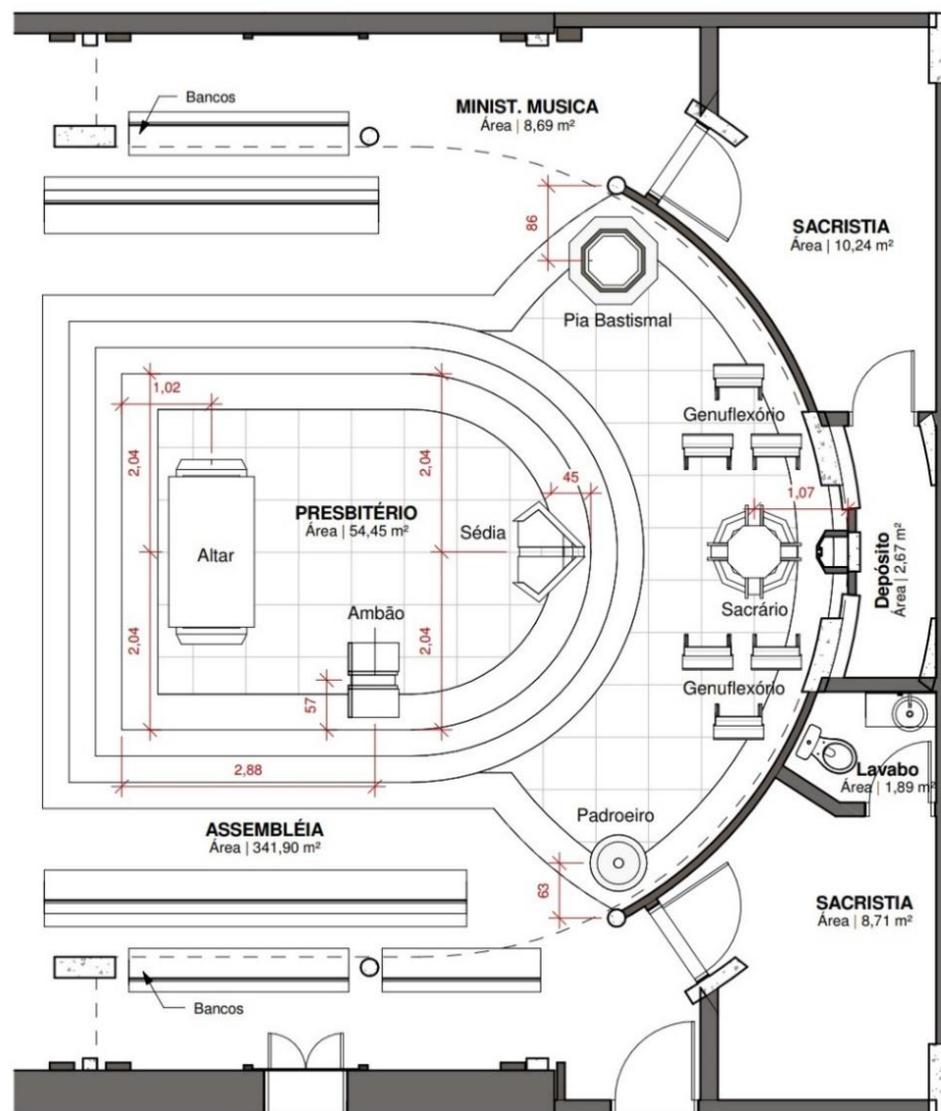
Planta baixa de Reforma da igreja Senhor do Bonfim (Presbitério e Mezanino)
